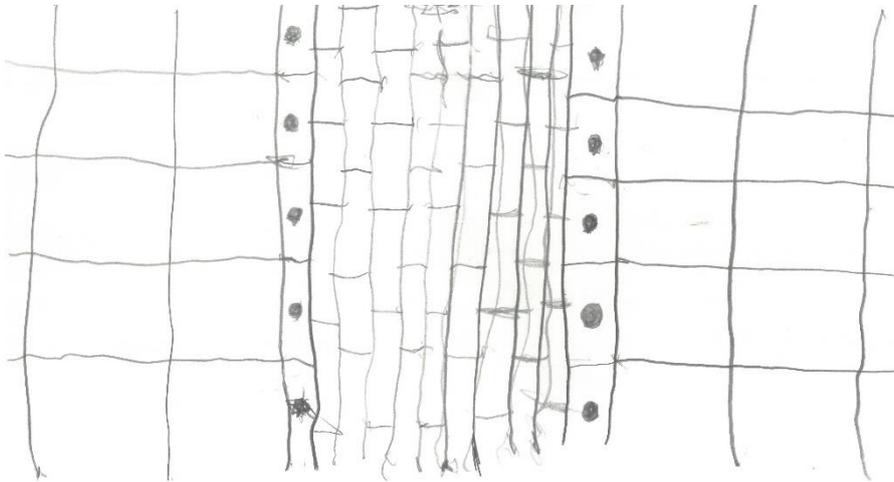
Esquízo de pormenor 2 do pavimento do espaço público do bairro da Parcela 6, em planta
